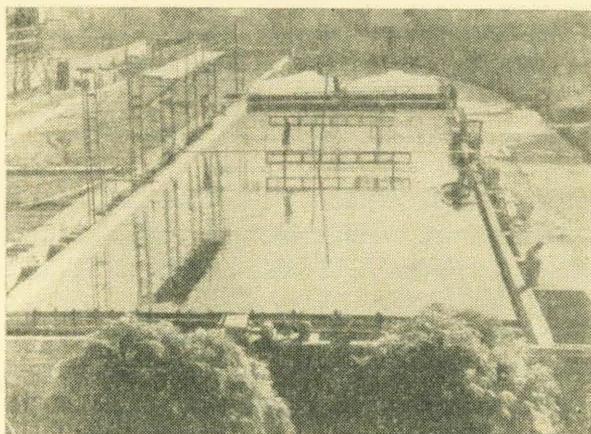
Общий вид опытного бассейна в Норкской лаборатории ИВП.
